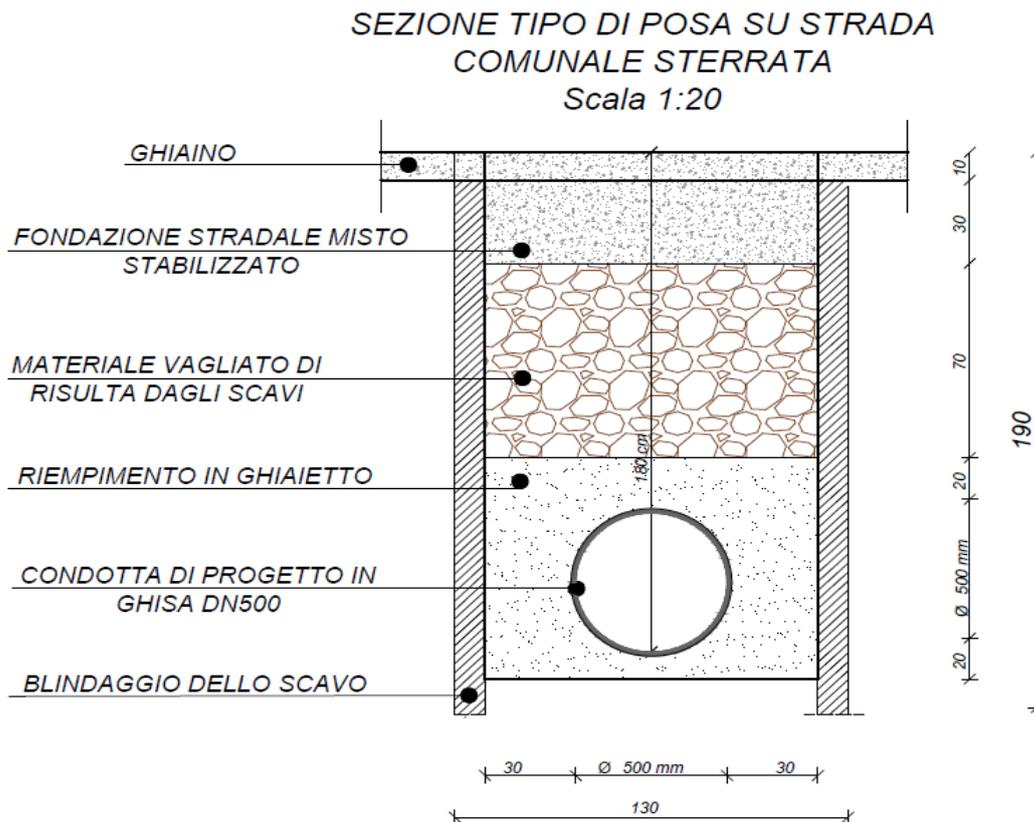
Sezione tipo di posa su strada comunale sterrata
